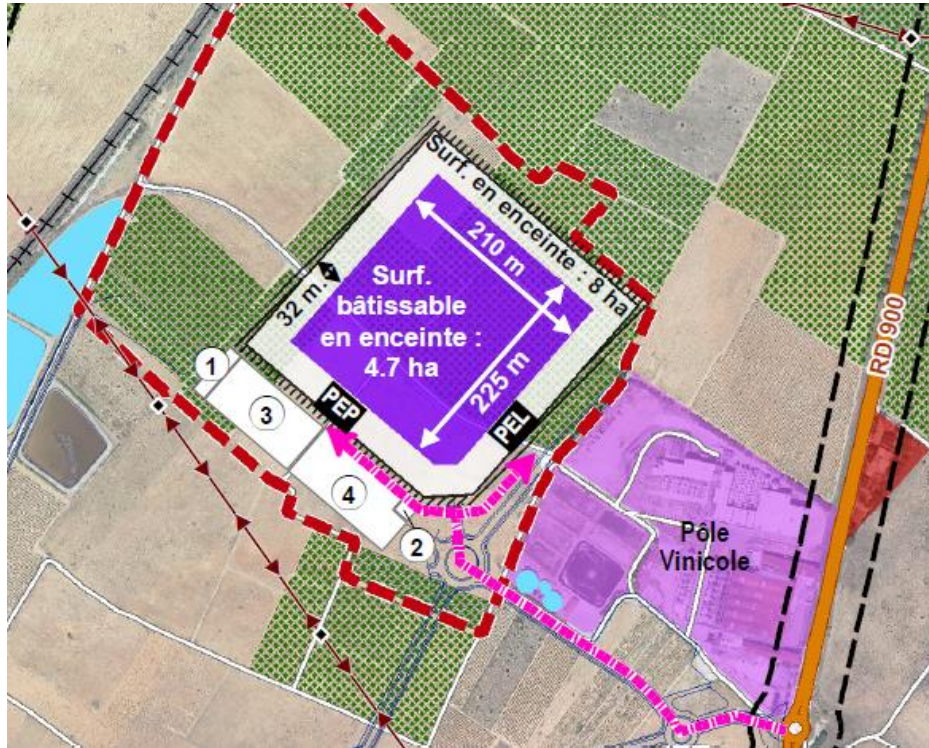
Plan de masse prévisionnel d'une maison d'arrêt
